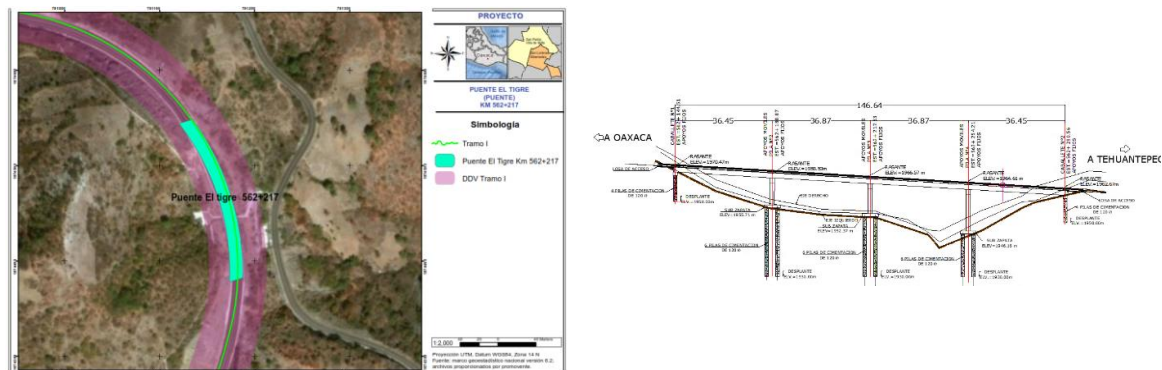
Proyecto en planta y perfil longitudinal del Puente El Tigre 562+217.
